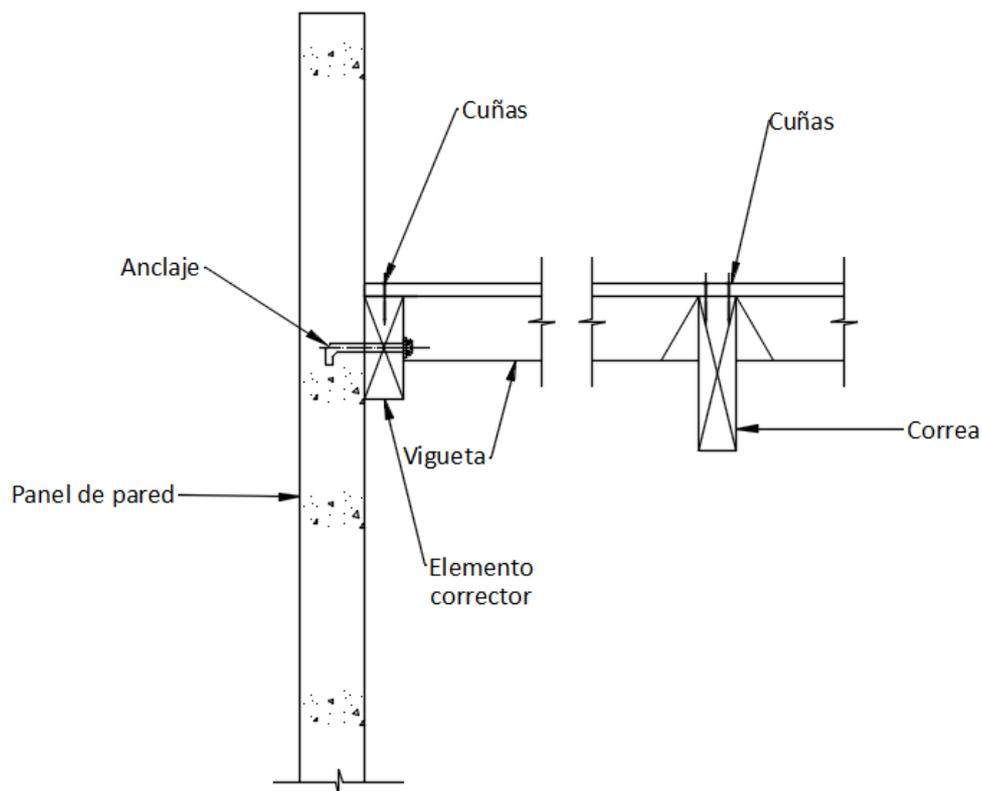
Inspeccionar el diafragma y sus elementos conectores en búsqueda de cualquier tipo de separación. El anclaje de conexión ilustrado en la figura esta típicamente expuesta a fallar por torcedura del elemento de anclaje.
